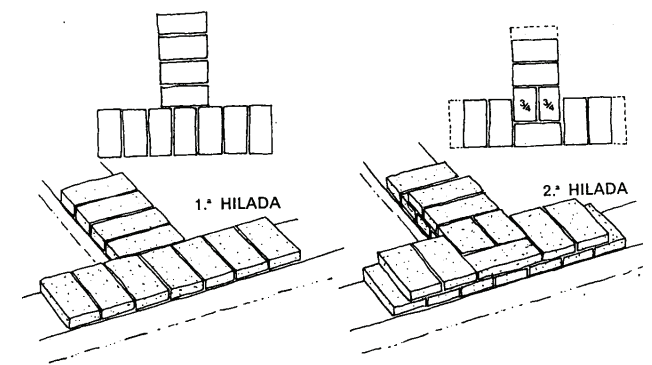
Encuentro de muro en "T" con juntas alternadas.
